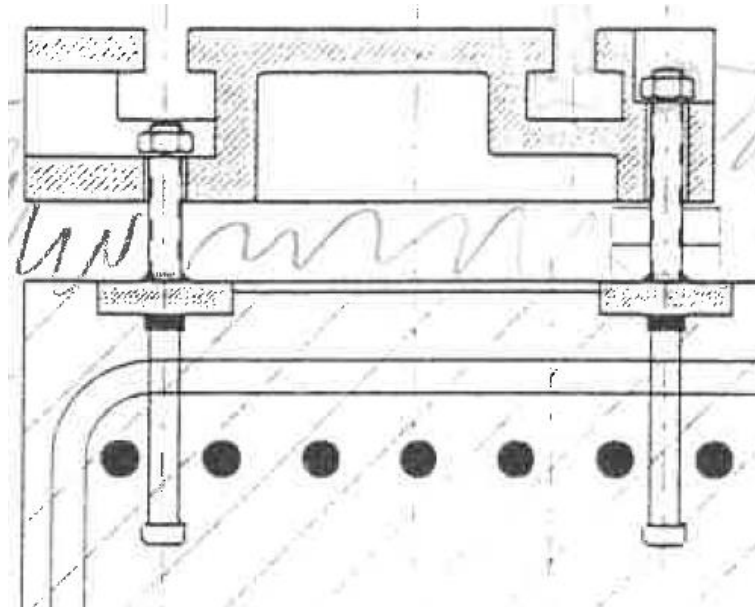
Pormenor de fixação do carril (Desenho VOITH, 1999)
